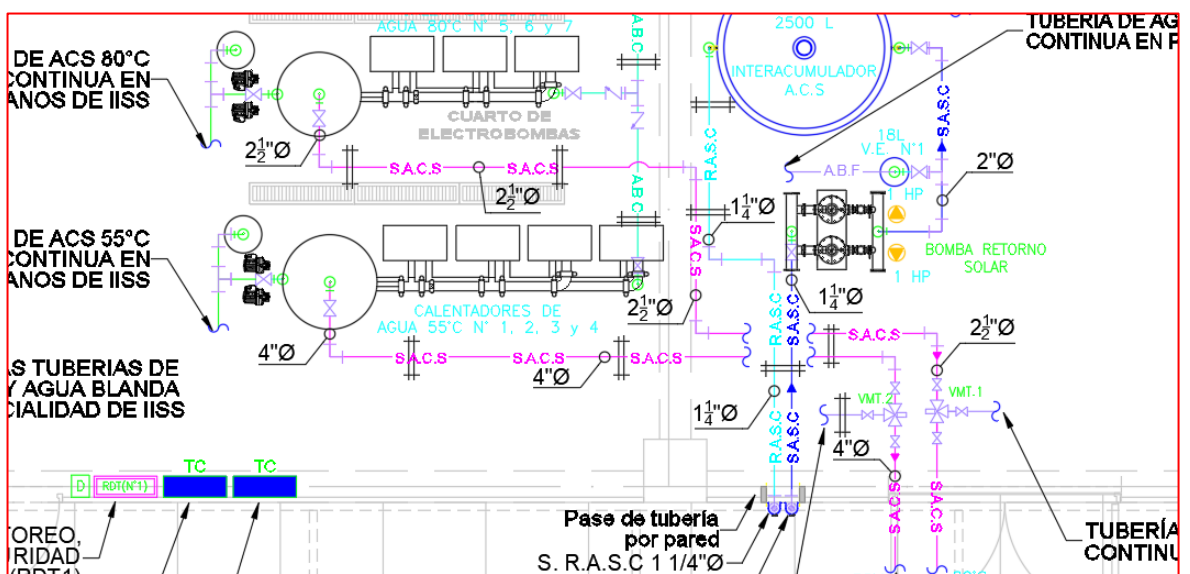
Medidas de las tuberías en el Esquema de Planta Ubicado en el Cuarto de Fuerza
